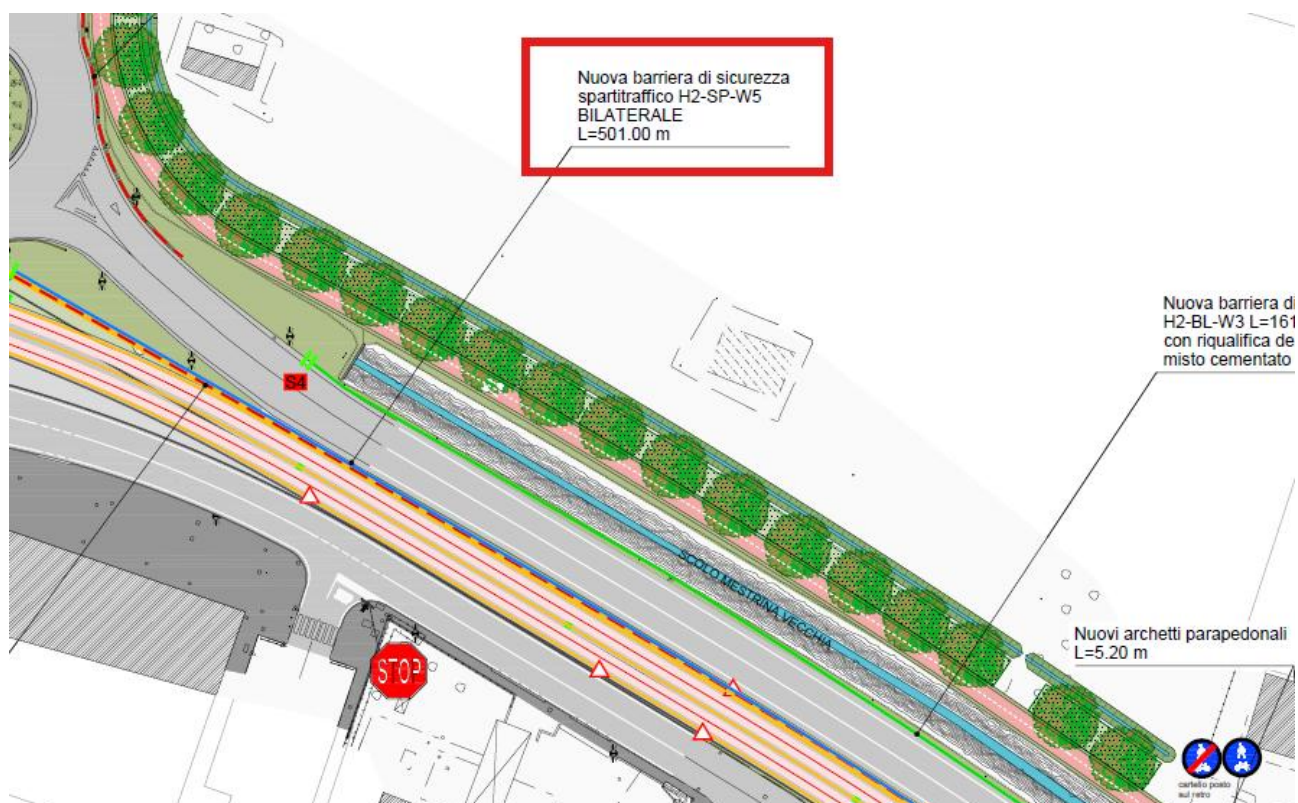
Ubicazione nel tracciato planimetrico di progetto esecutivo di barriera di sicurezza H2 spartitraffico infissa nel terreno, oggetto di proposta di sostituzione – tratto Ovest L = 500m ca.
